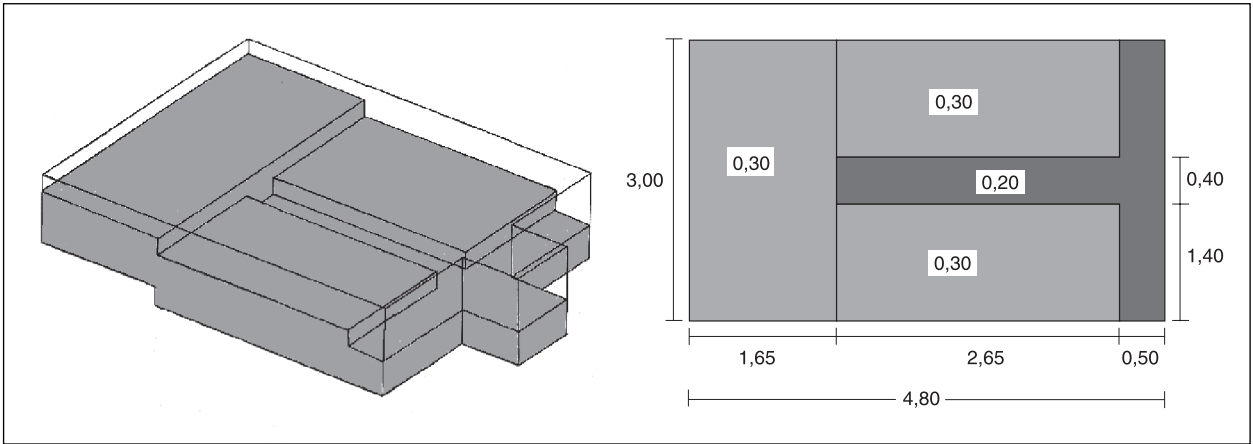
Fondations de la borne-fontaine et de son aire de lavage. A, vue en perspective. B, plan (dimensions en m).
